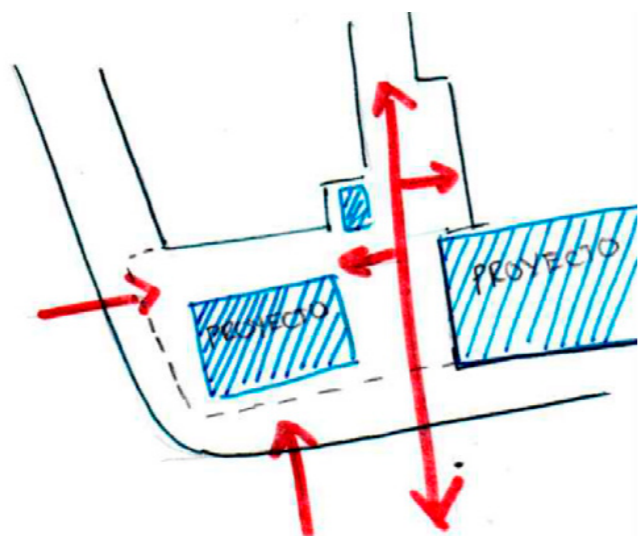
Planta baja, conexión con la ciudad. Fuente propia
